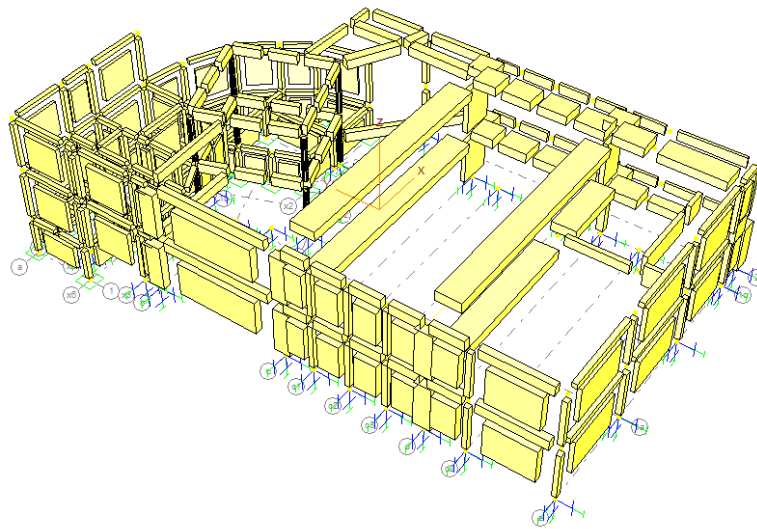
Diseño de columnas, vigas y trabes. Edificio de estacionamiento
